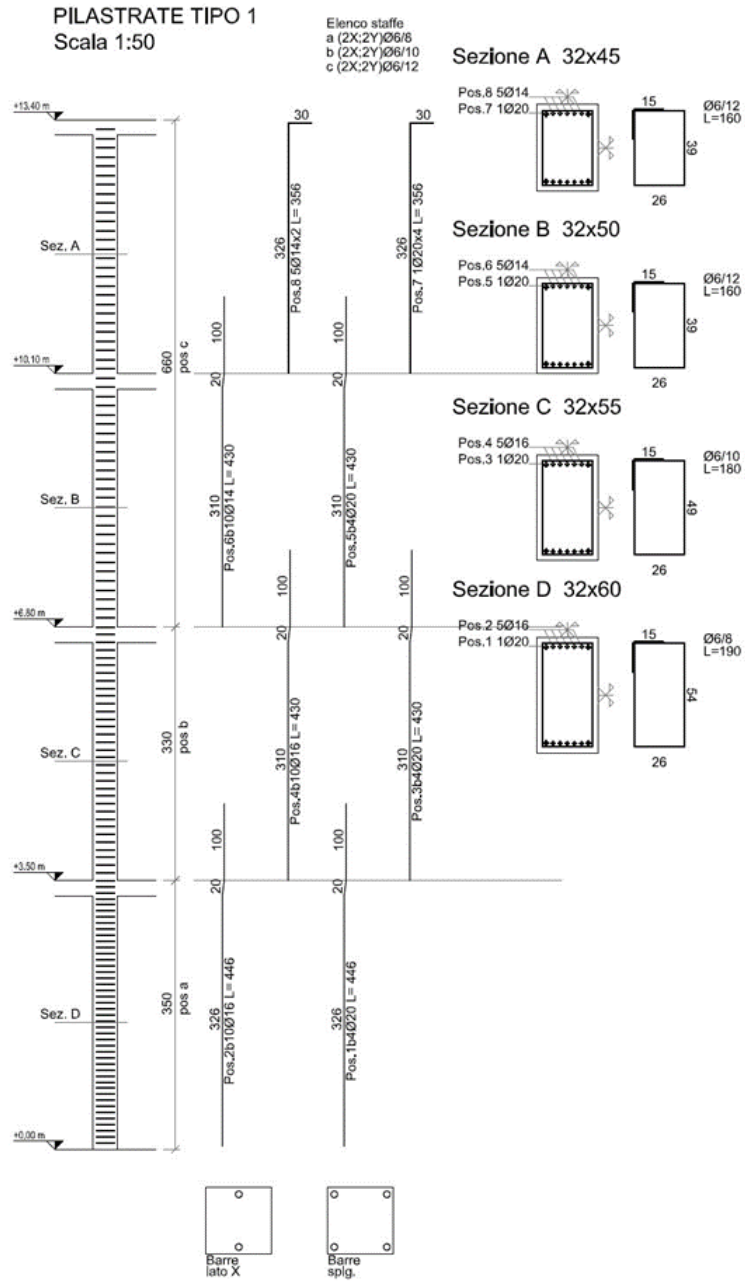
Armatura longitudinale e trasversale per pilastri di tipo 1.
